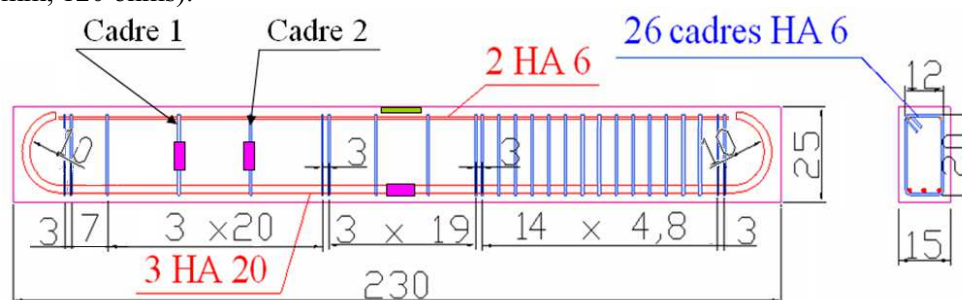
Plan de ferrailage des poutres sous dimensionnées à l'effort tranchant et positionnement des jauges de déformations sur l'acier et le béton
